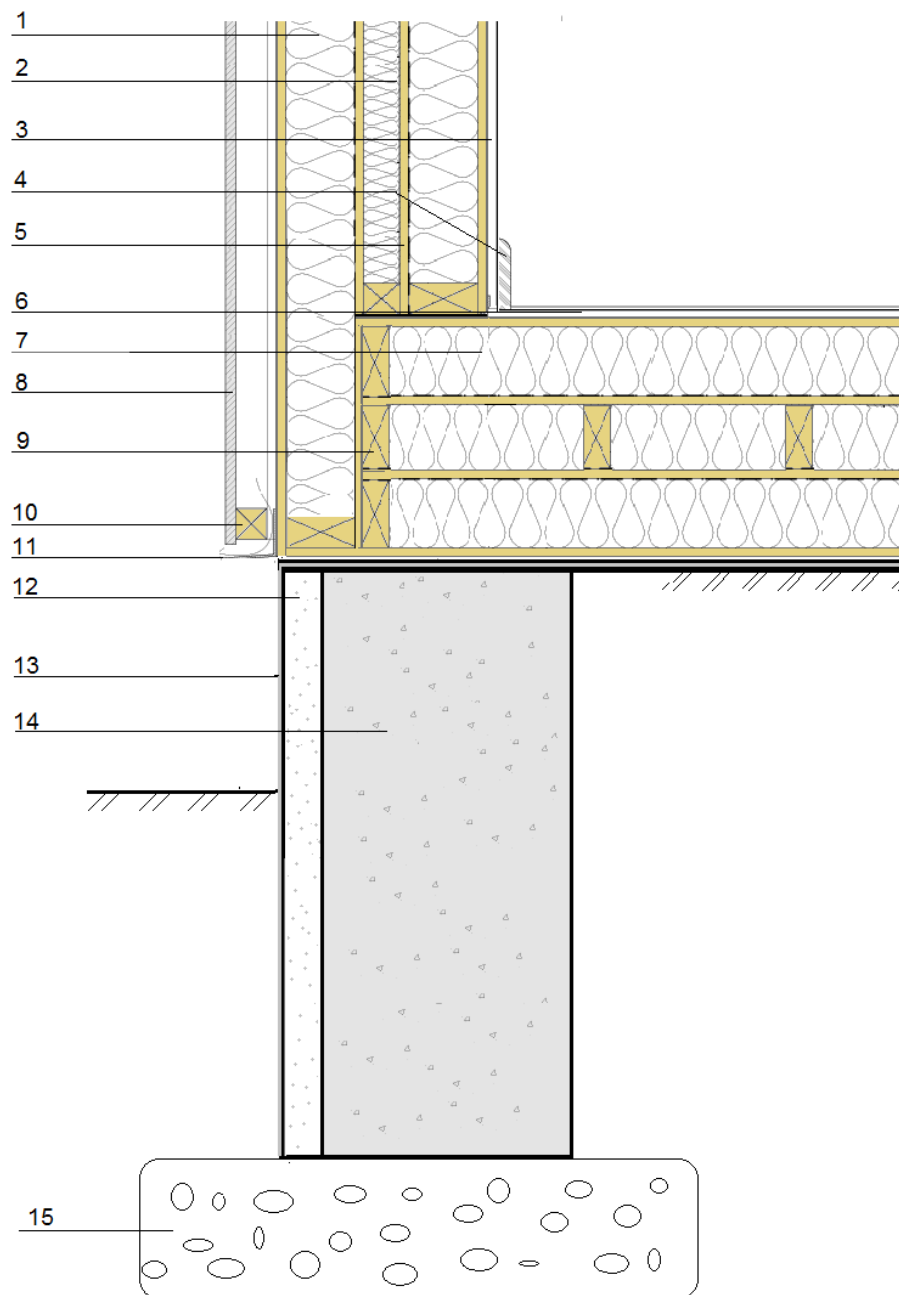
Утеплення фундаменту і влаштування перекриття по ґрунту
